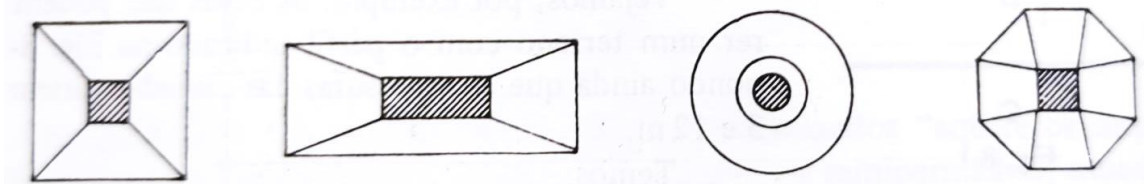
Várias formas em planta que uma sapata pode apresentar (Caputo, 1988).
